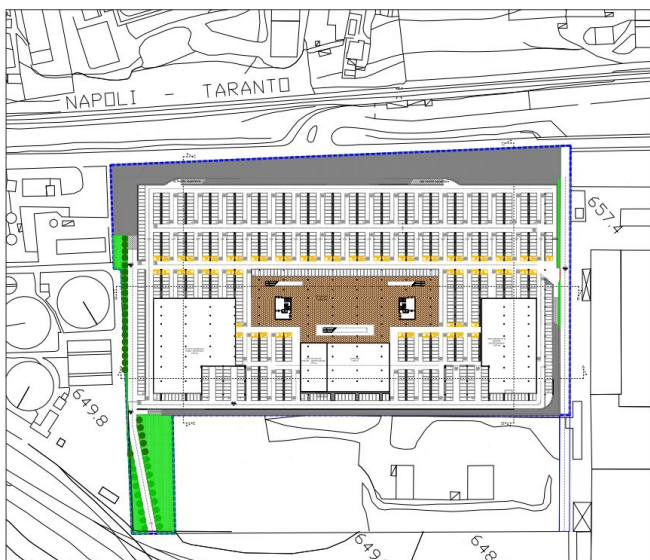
Planimetria di progetto – aree di parcheggio quota -5,00m
